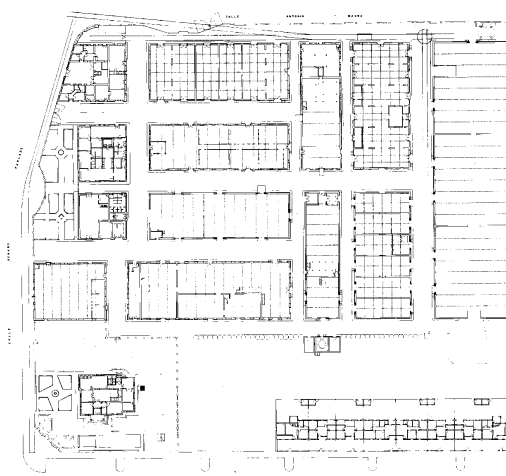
Planta general del conjunto de edificios tras la ampliación. (Fuente: SV60 Cordón & Liñán Arquitectos)
